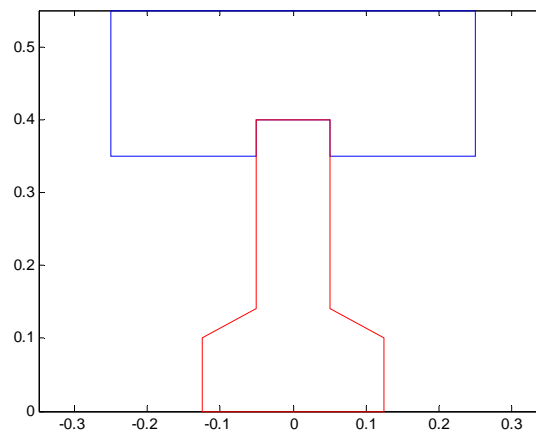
Viga armada de forjado unidireccional con losa de compresión
